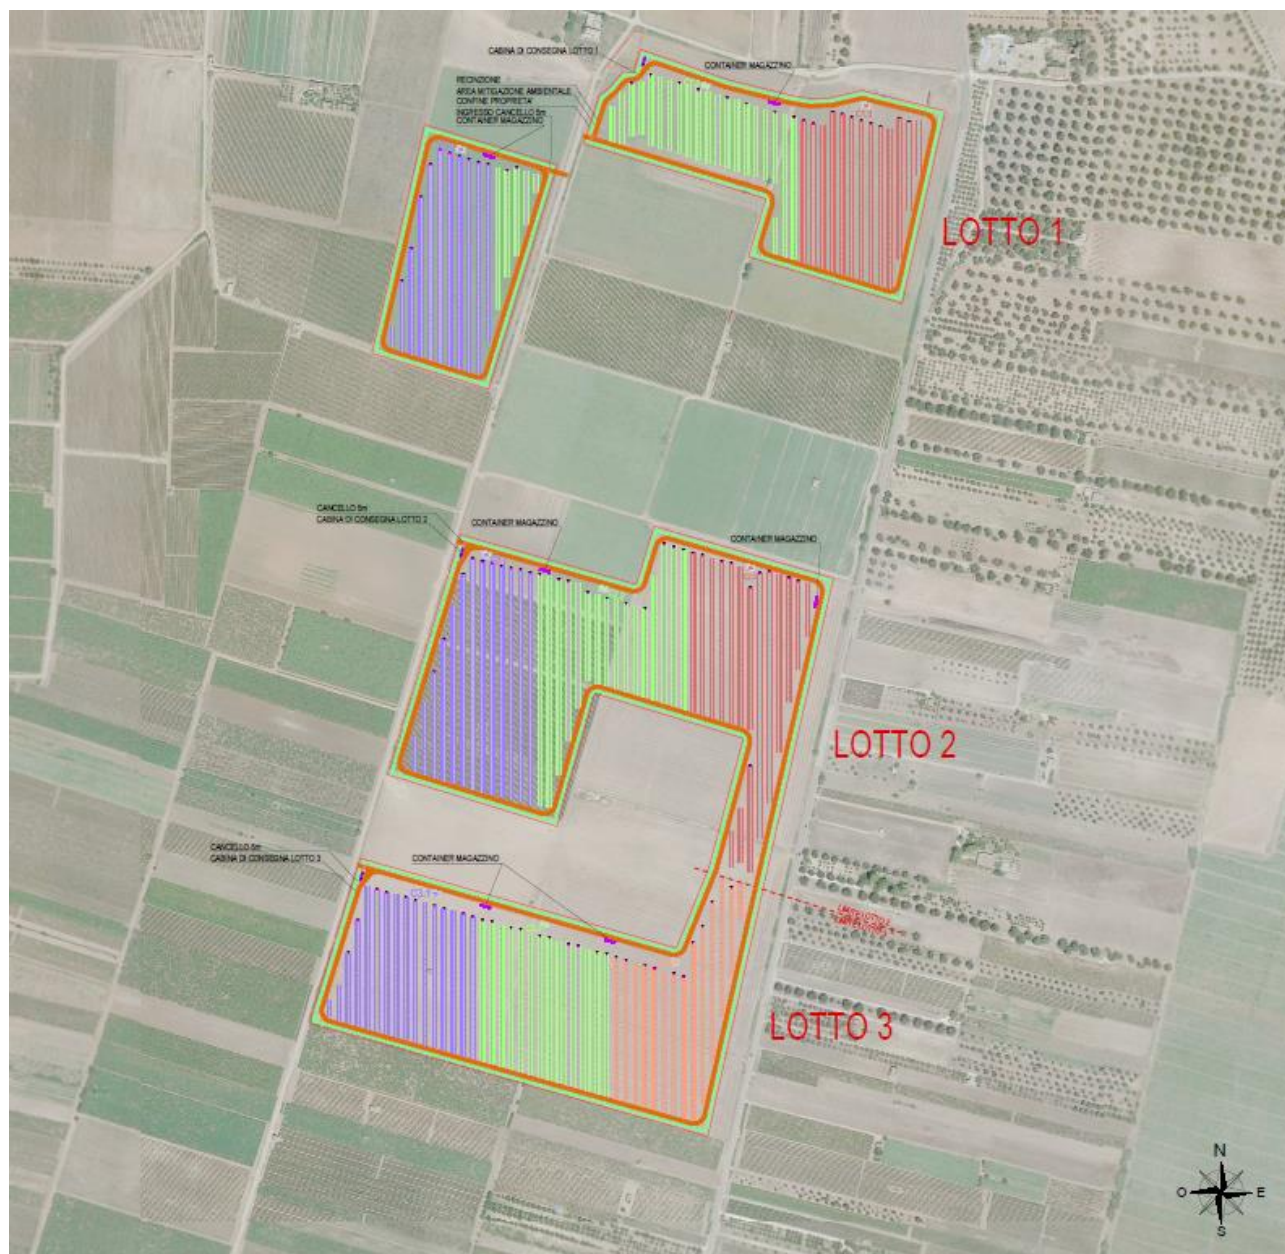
Planimetria generale di progetto su ortofoto
